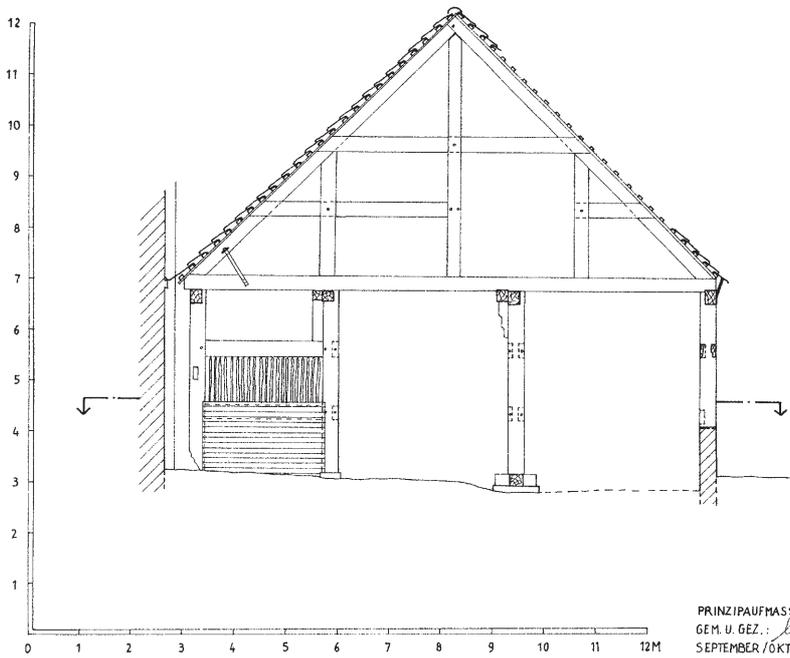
Grundriss und Schnitte eines Wirtschaftsgebäudes in Genauigkeitsstufe II, Maßstab 1:50 mit großer Informationsdichte und gut beobachteten Details
